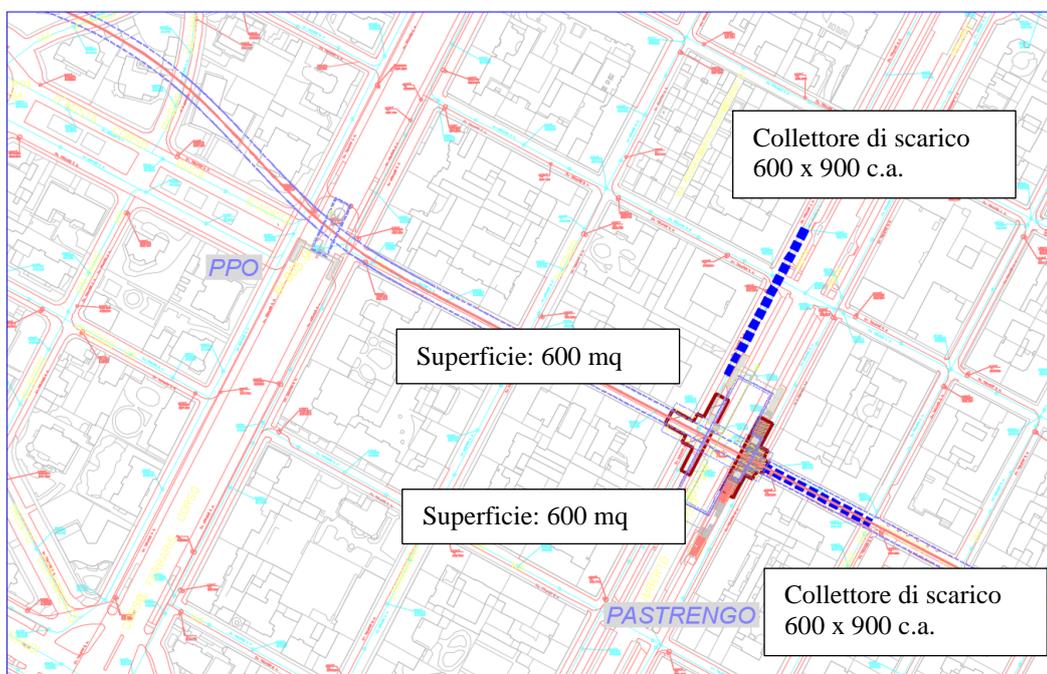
Aree di cantiere – Stazione Pastrengo – FASE 1
